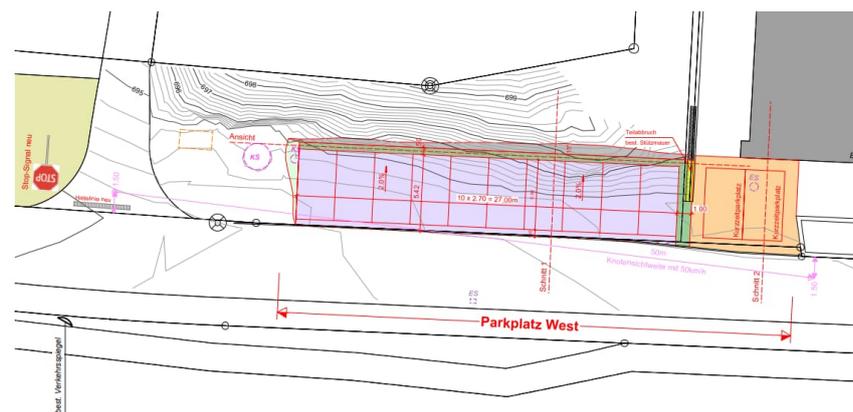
Vorprojekt; Parkplatz, Situation (Ausschnitt Parkplatz West), Gasser Engineering AG, rev. 17.08.2023
